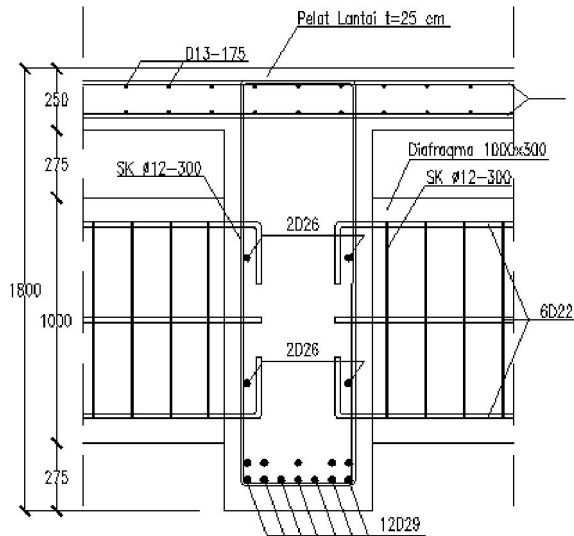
14. Rekap Perhitungan Girder Tepi
